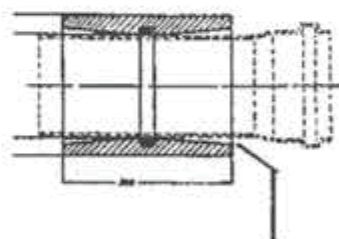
Beispiel eines gelenkigen Schachtanschlusses mit geschlossener Rohrdurchführung und Reinigungsrohr
